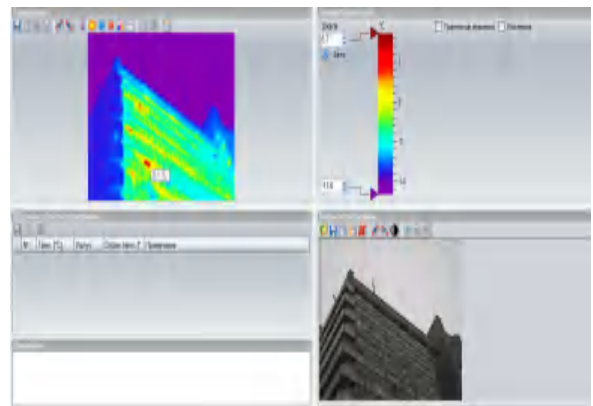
Термограма частини зовнішньої стіни будівлі ДВНЗ ПДАБА з відміченою найбільш гарячою точкою / Fig. 5. The thermogram of the outer wall of the building SHEE PSABEA marked with the hottest point
